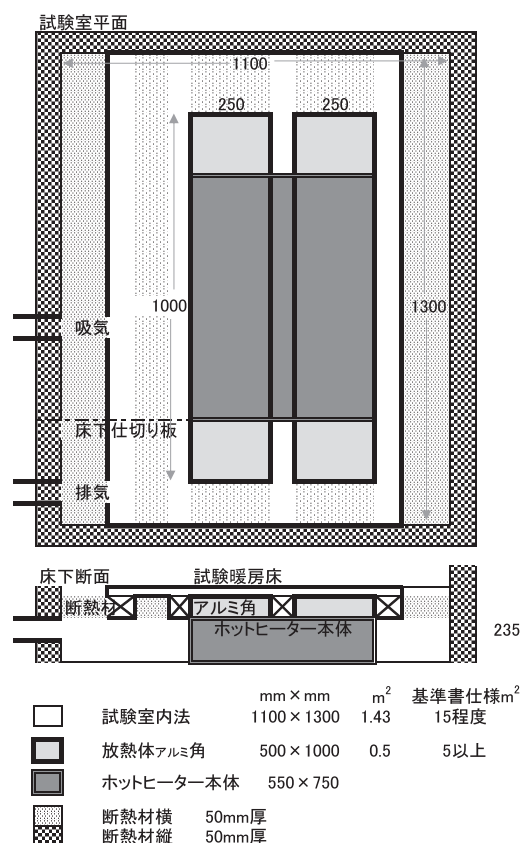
施工面 - 熱性能 - 環境試験の試験平面、断面図
